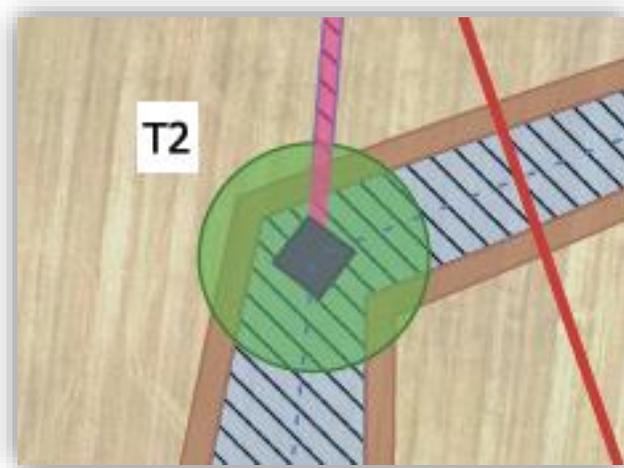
Imagen de planta de ocupación temporal para montaje y construcción de la línea (superficie sombreada en verde en el centro de la imagen, alrededor del apoyo en color gris).
